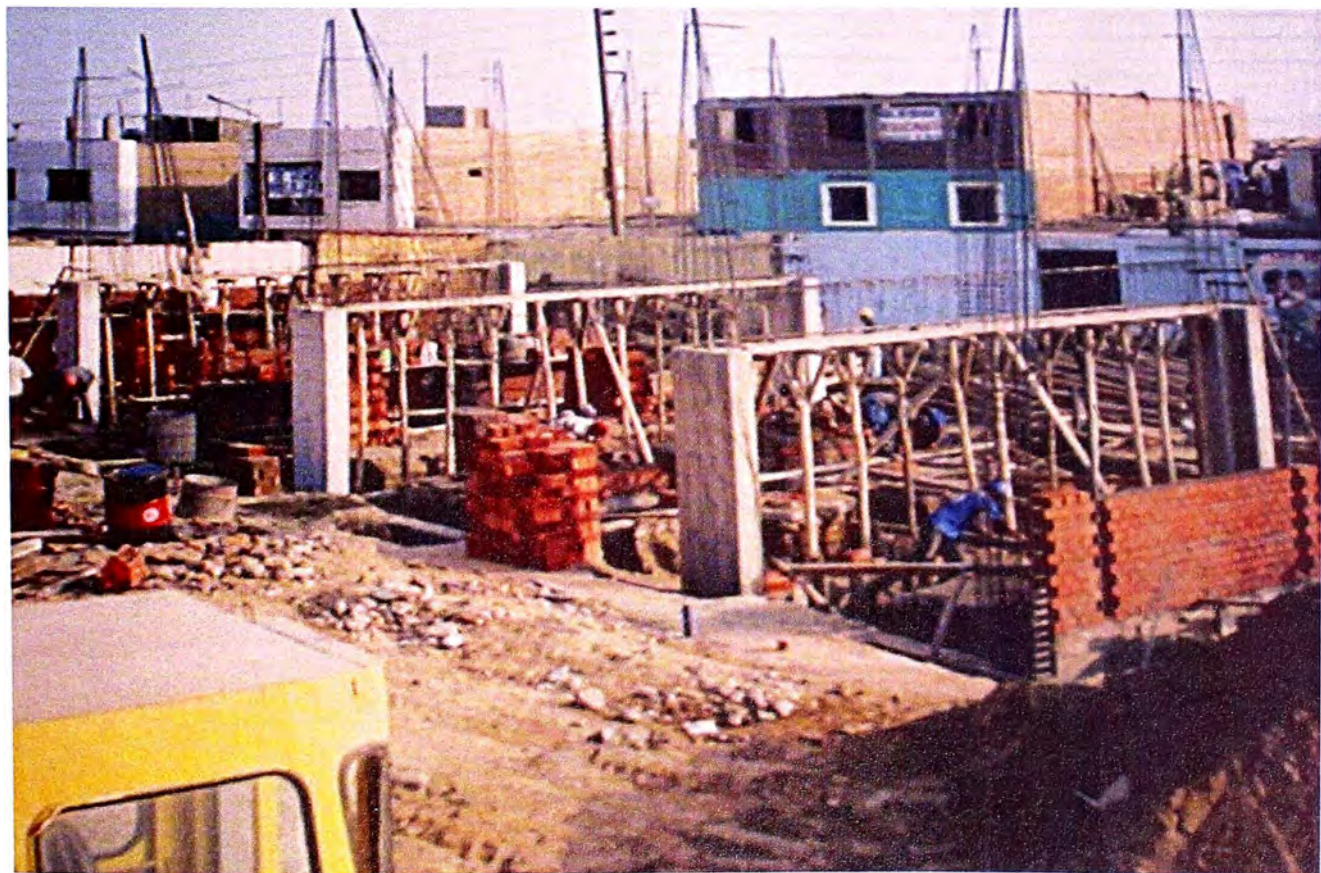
VISTA DE PLACAS VACEADAS Y ENCOFRADO DE FONDO DE VIGAS
